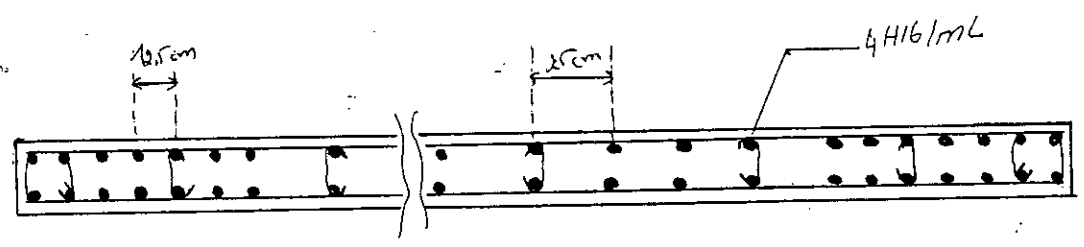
SCHEMAS DE FERRAILLAGE DU VOILE (E)
